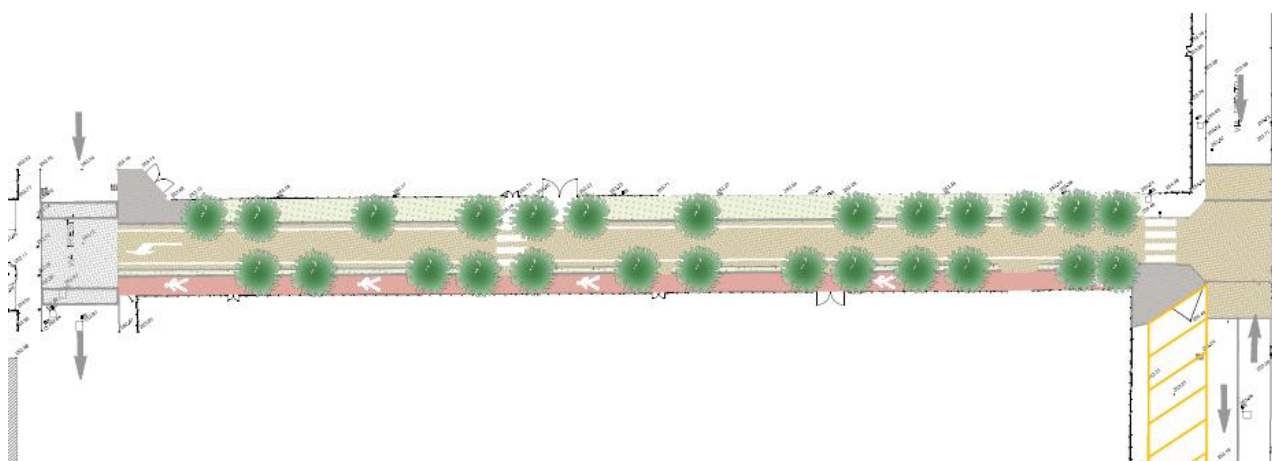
Inquadramento planimetrico Via delle Rimembranze
